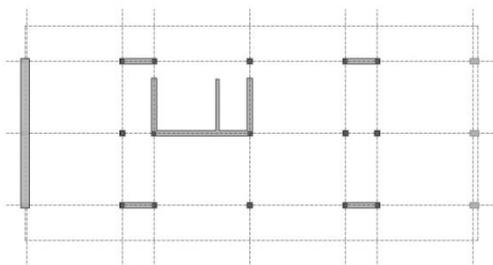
Esquema estructural en planta baja (elaboración propia)
